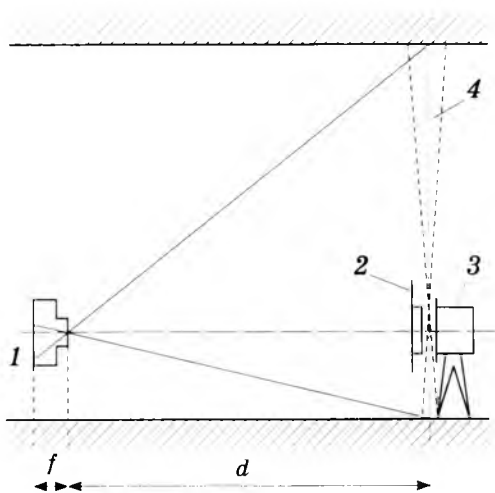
Схема светопрофильной съемки сечений выработки
